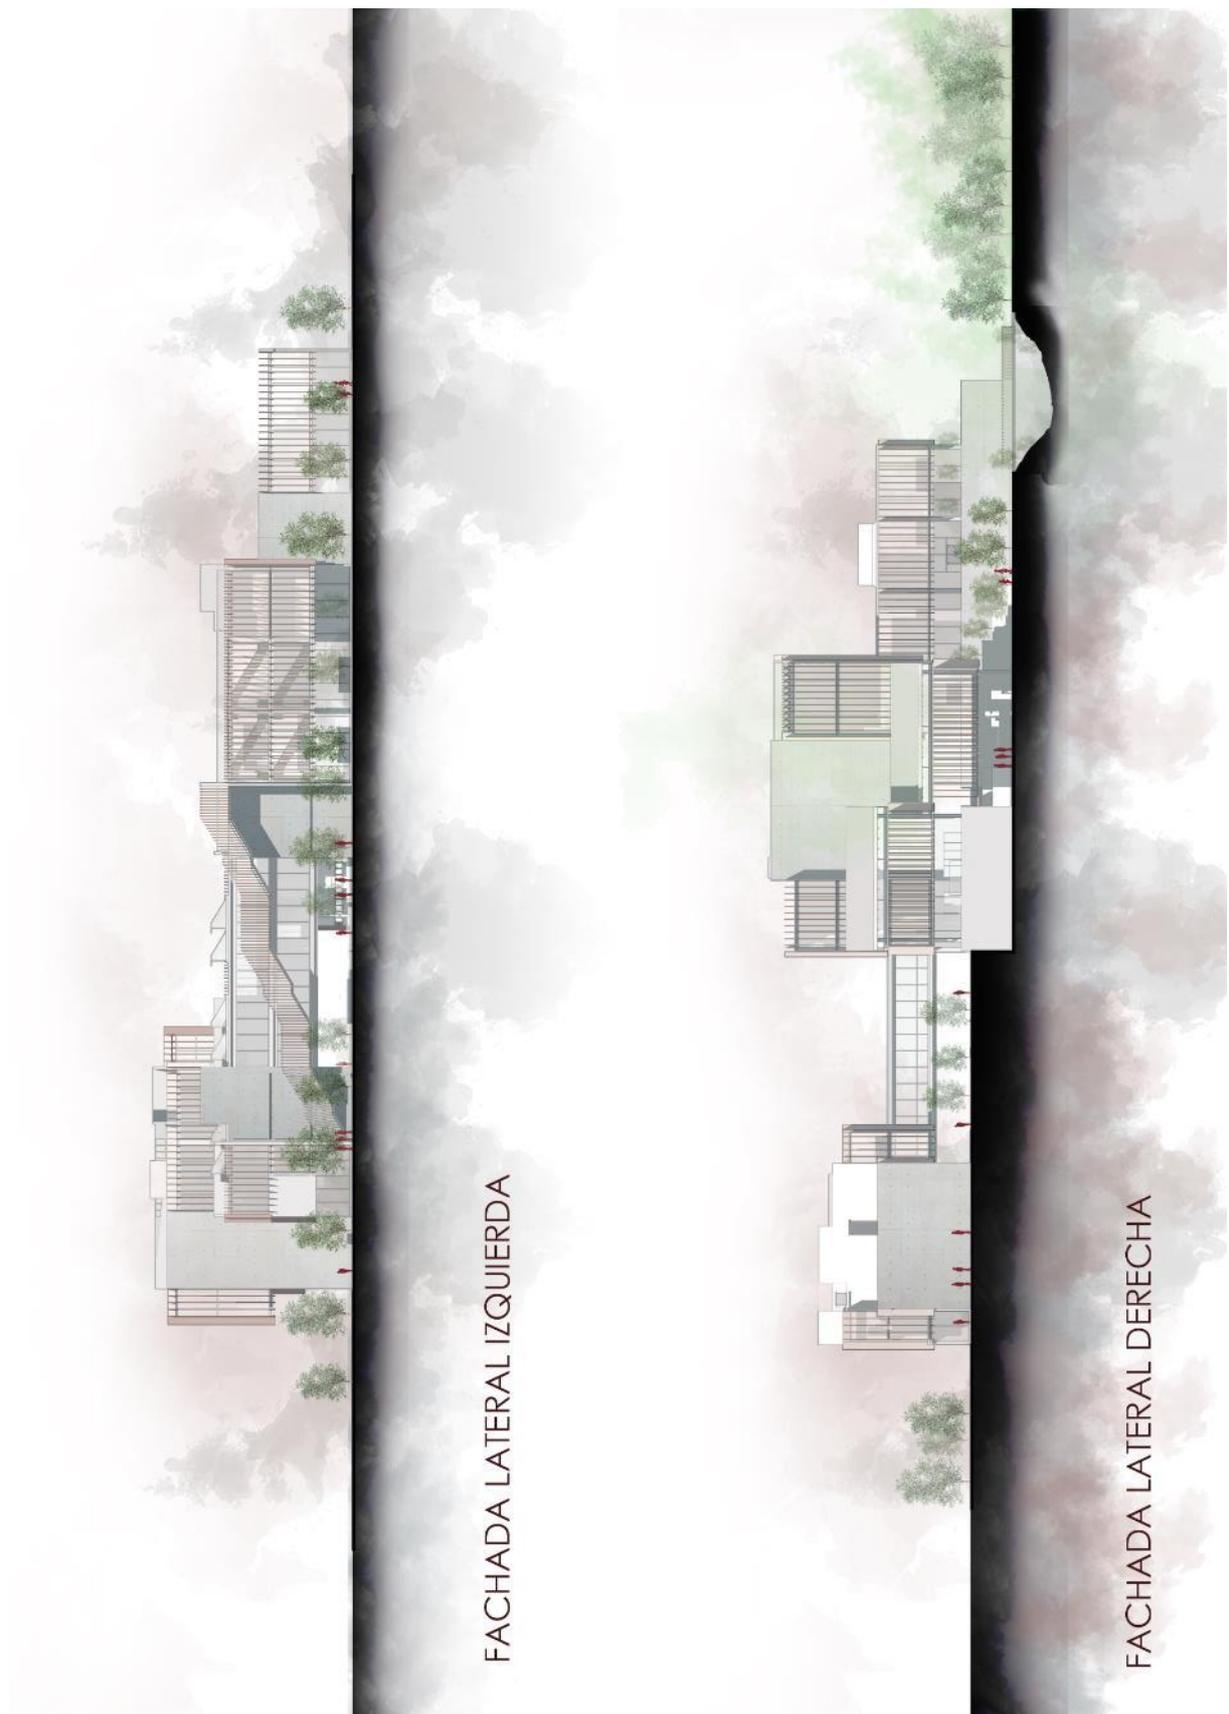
Fachadas lateral izquierda y derecha Elaboración propia
